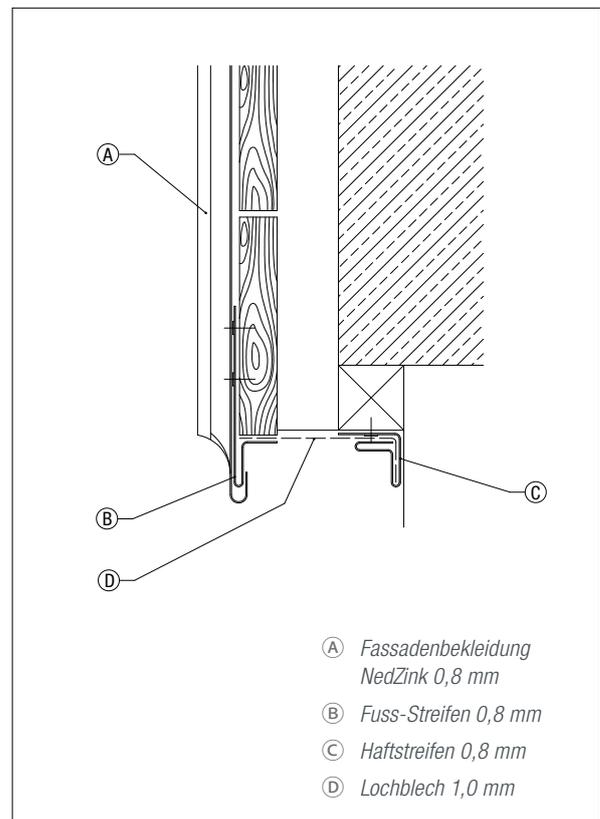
Winkelstehfalz Unterer Anschluss Fassadenknickpunkt Fassade
